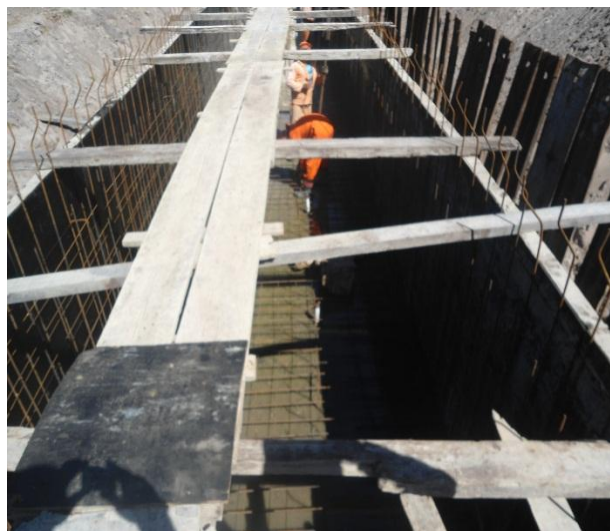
Montagem da armadura da laje inferior e das paredes da galeria celular de dimensão (250 x 140) cm entre as estacas 9 e 10 na Av. Walter Bezerra de Sá.
